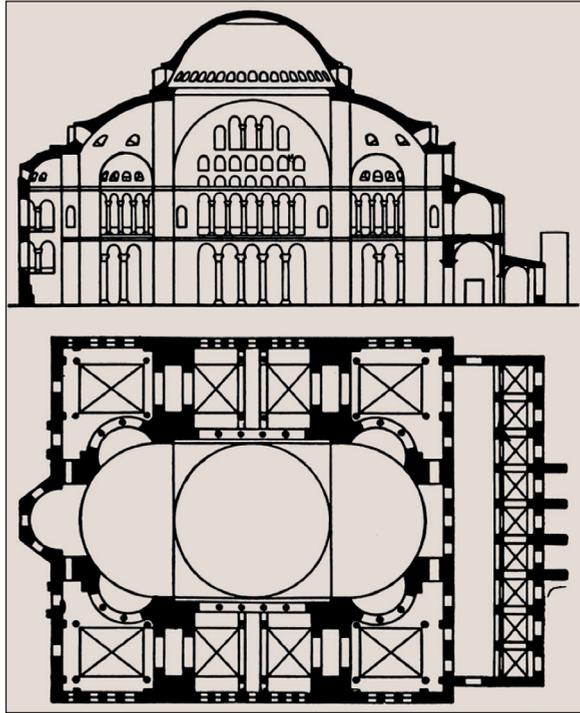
Planta y alzado de la basílica de Santa Sofía de Constantinopla (532-537).
